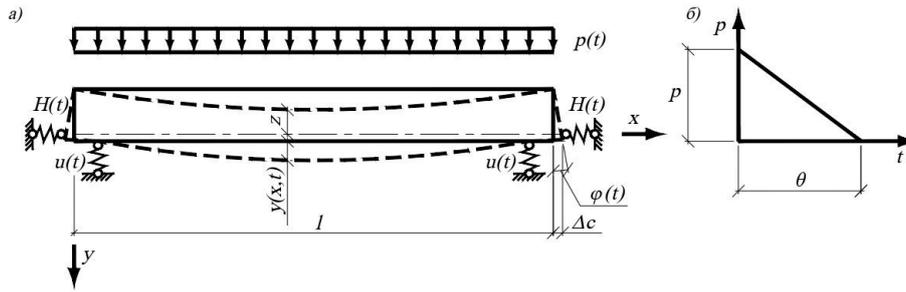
Расчетная схема железобетонной балки с распором на податливых опорах (а), закон изменения кратковременной динамической нагрузки (б)
